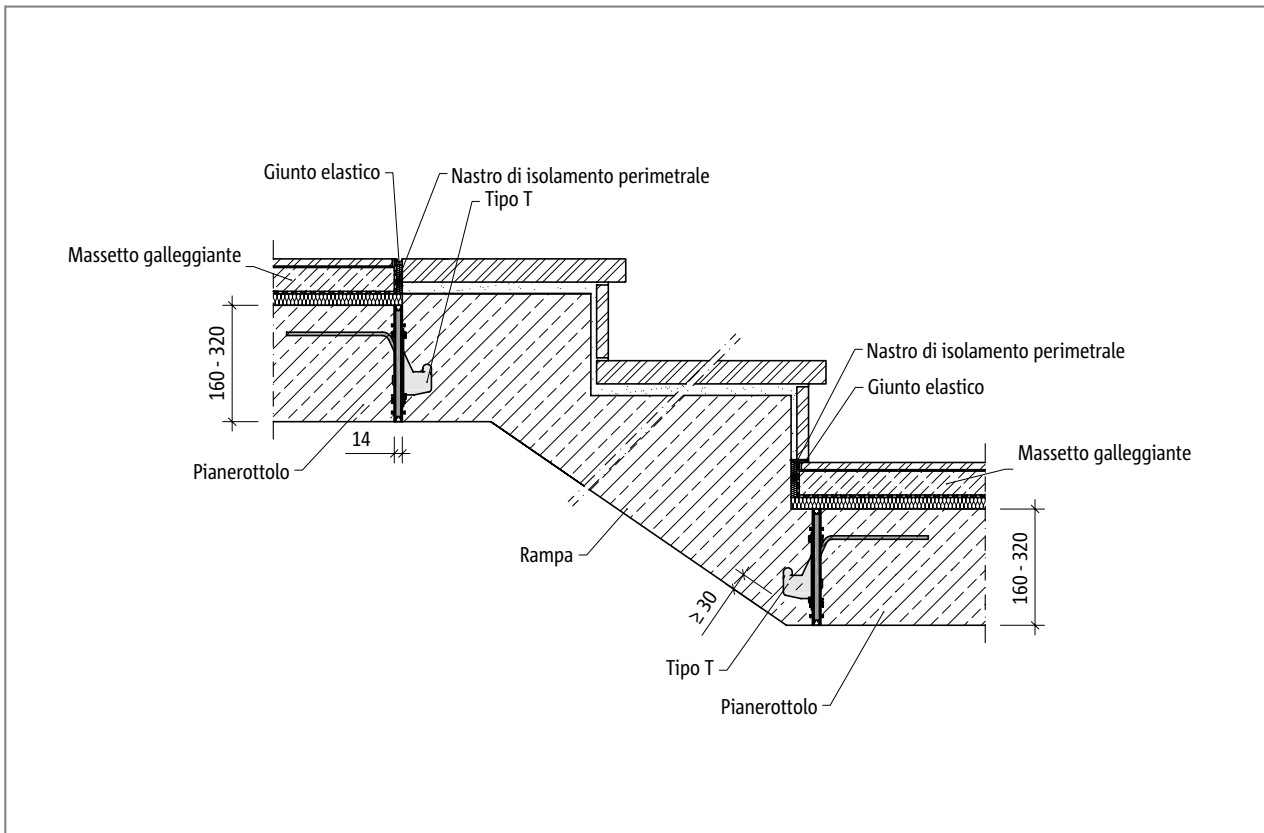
Schöck Tronsole® tipo T, Sezione costruttiva
